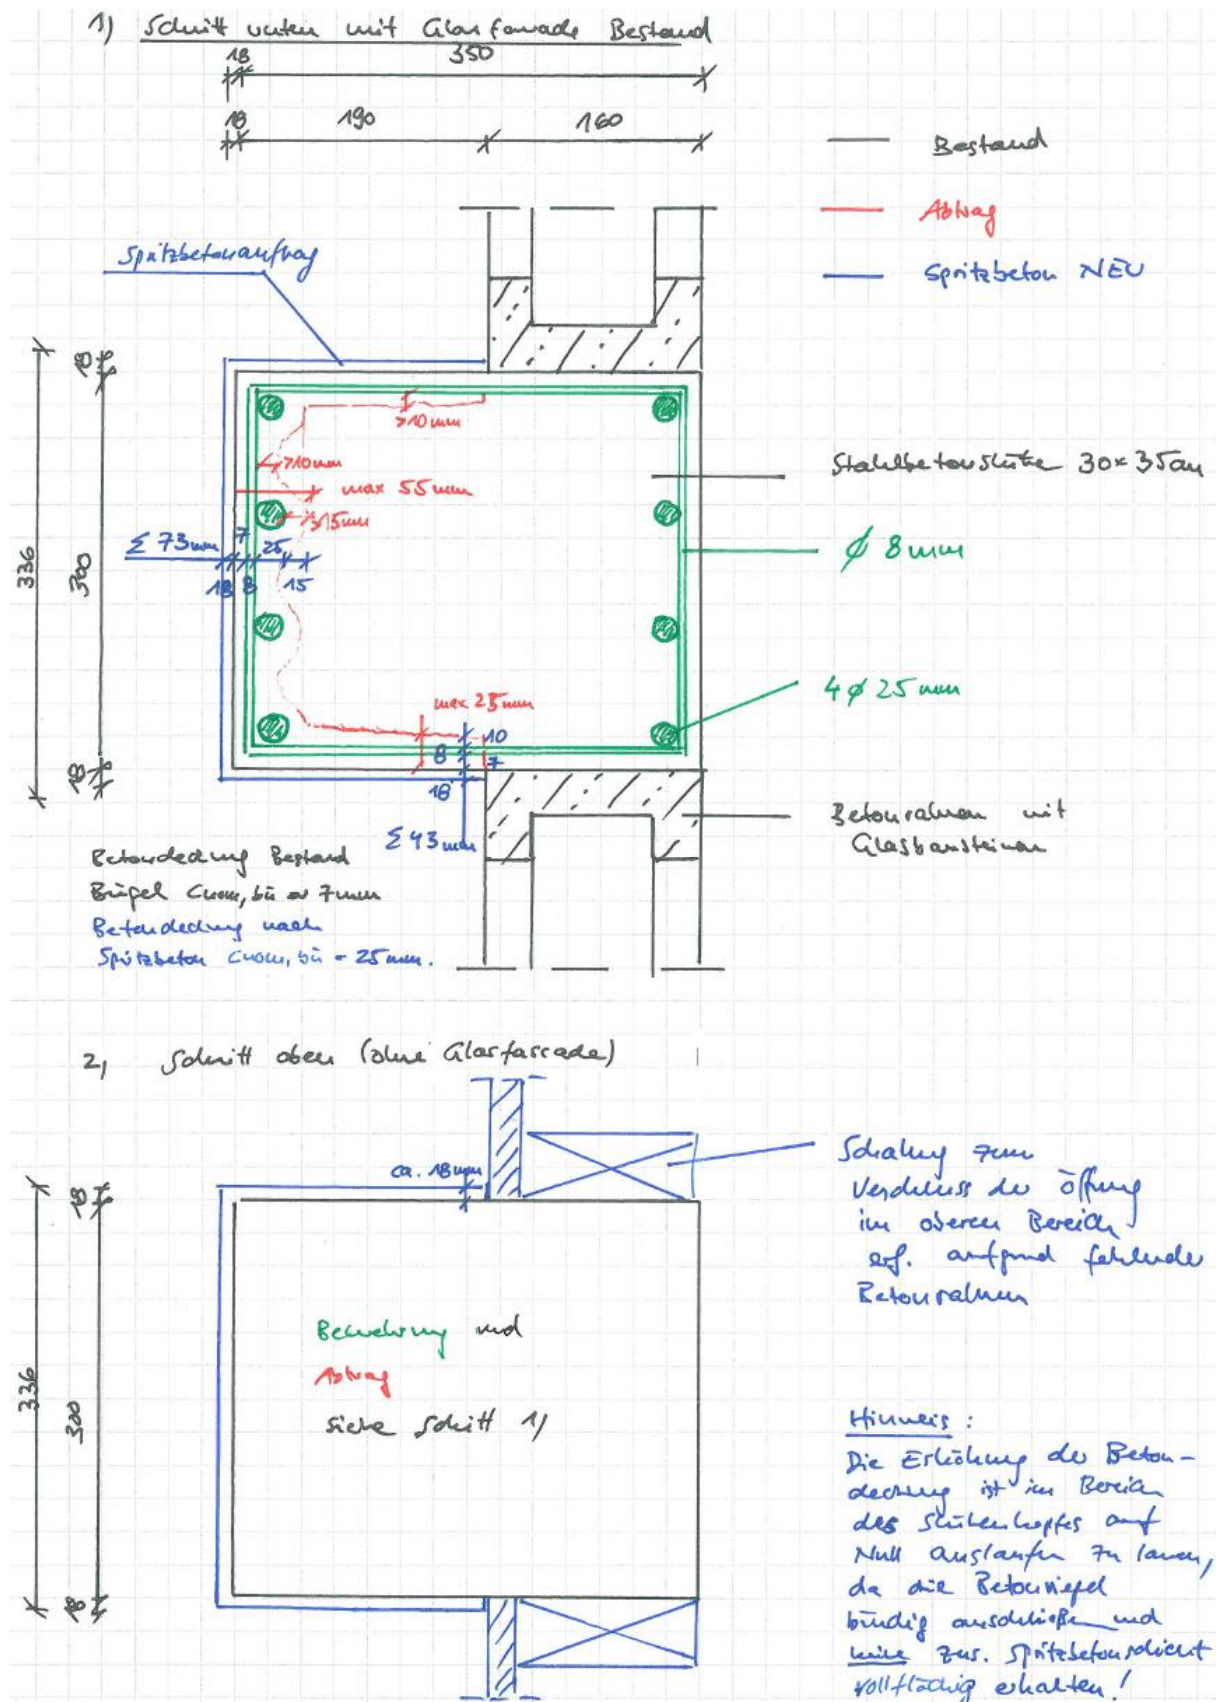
Prinzipskizze der Betonsanierung an den vorliegenden Stützen der NW-Fassade mit Glasfassade (Schnitt 1) und ohne Glasfassade (Schnitt 2)
